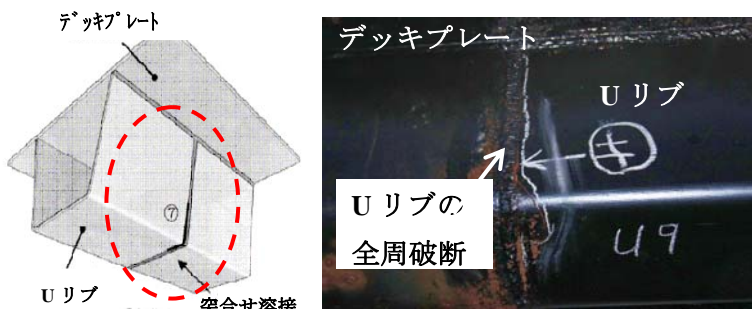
Uリブ突き合わせ溶接部の損傷状況
